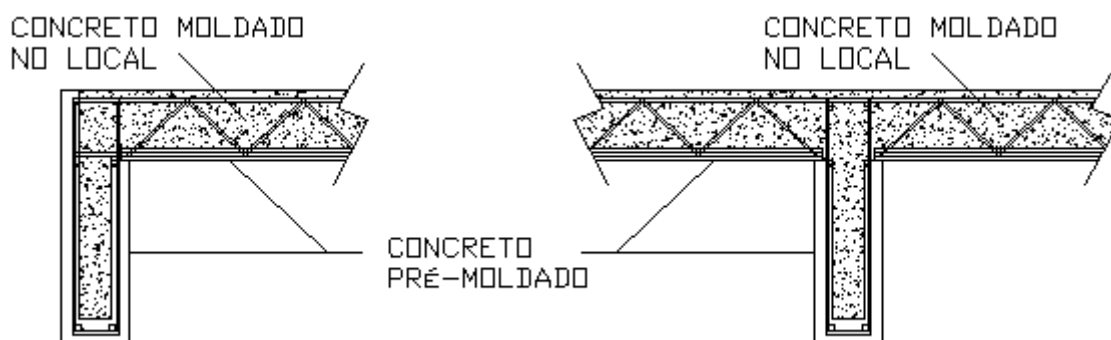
Elementos pré-formados tipo viga e laje treliçada
